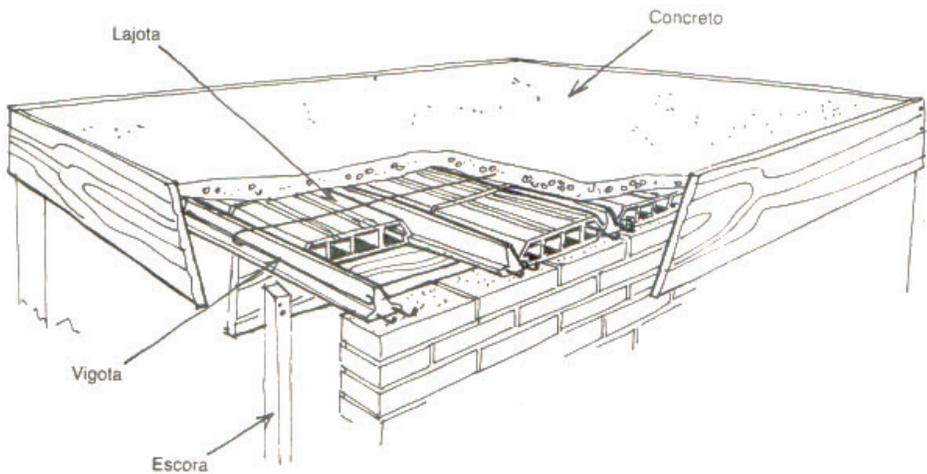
Esquema de laje mista usualmente empregada em edifícios de múltiplos pavimentos
